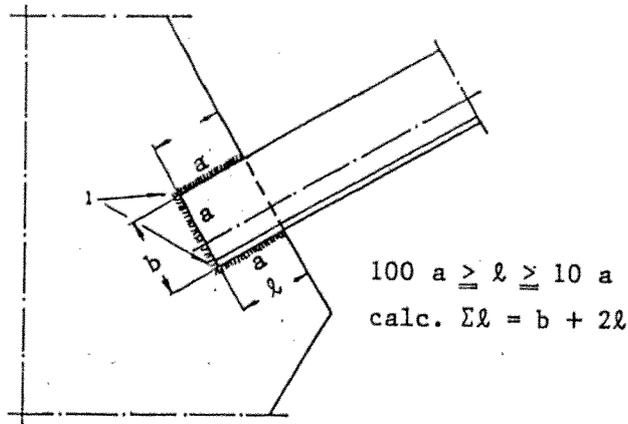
Empalme con soldaduras de filete en los flancos
